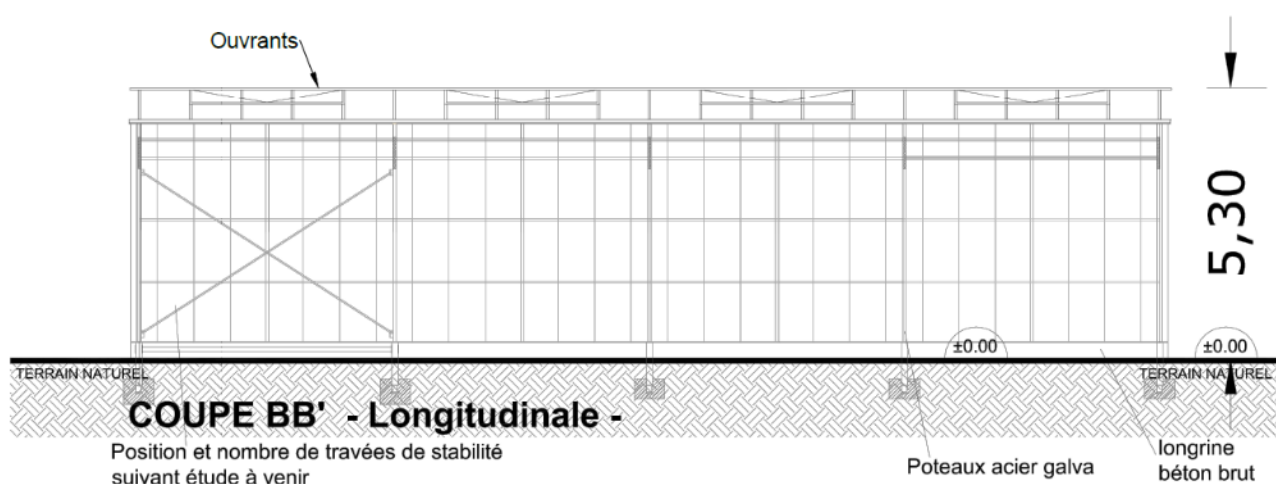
Coupe type serre multi-chapelles, côté long pan. Reden.
